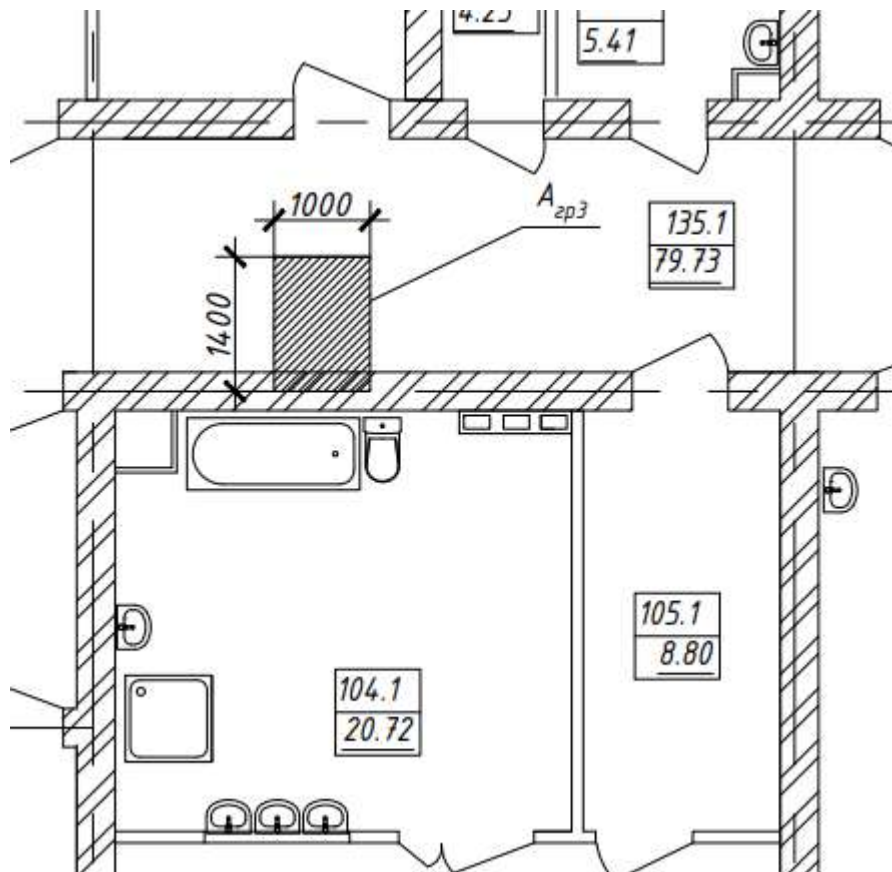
Фрагмент плана с грузовой площадью для фундаментов, расположенных в осях 34И (b=1 м)
